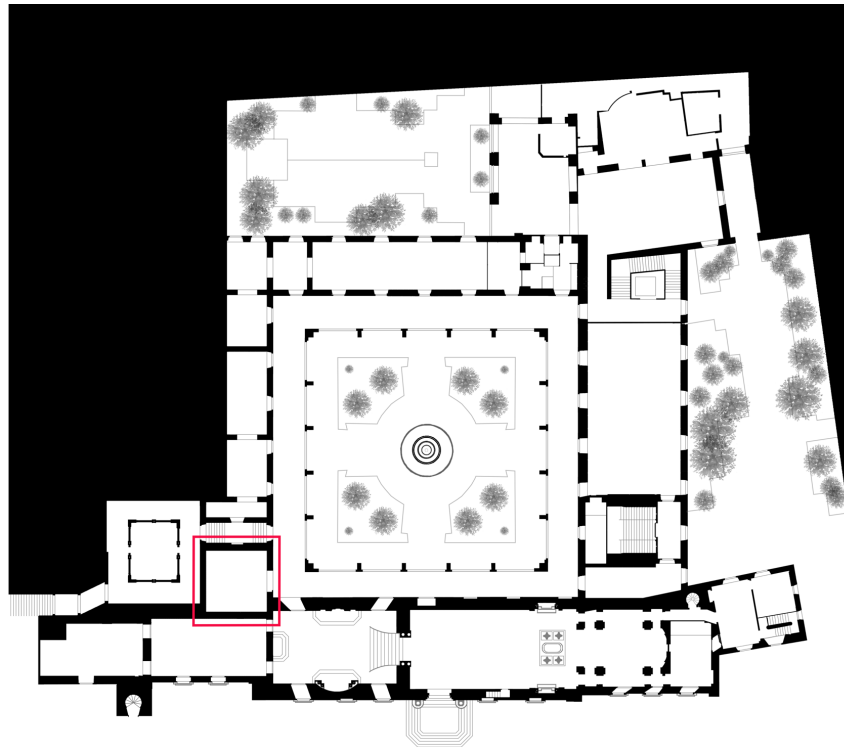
Planta de localização do local em estudo. Sala Árabe.
